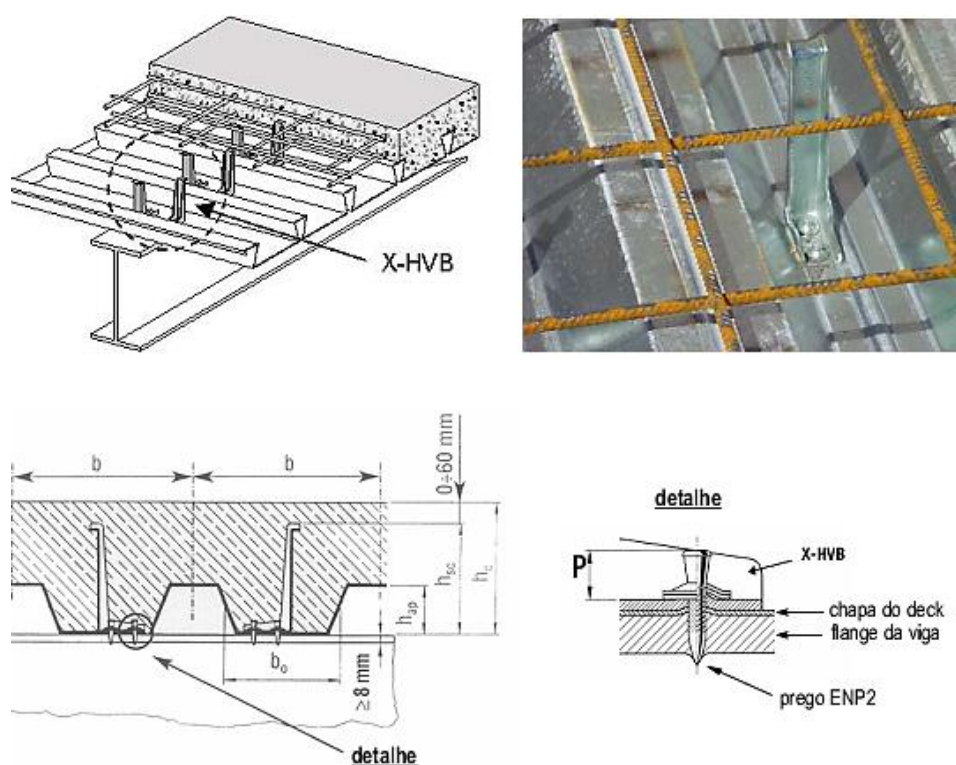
Conector não soldado Hilti (Crisinel, 1990).
